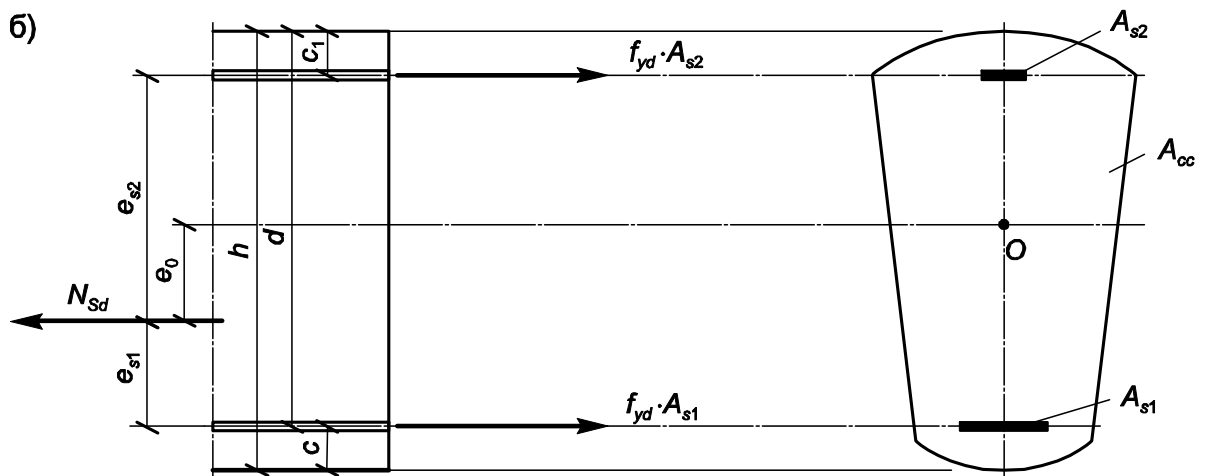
Схема усилий и эпюра напряжений в сечении, нормальном к продольной оси внецентренно растянутого железобетонного элемента, при расчете по прочности (случай малого эксцентриситета)
